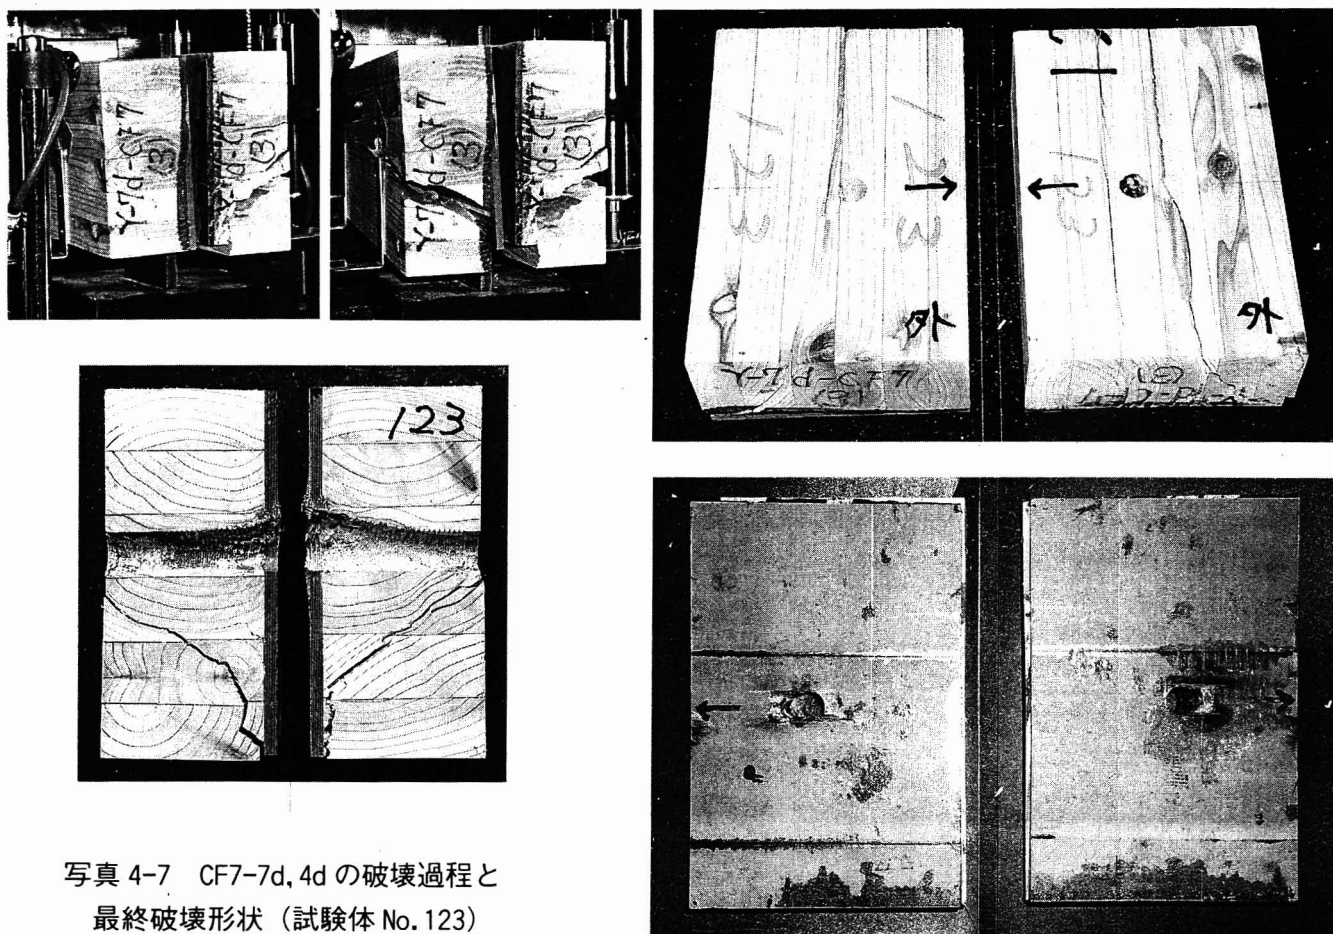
CF7-7d, 4d の破壊過程と最終破壊形状 (試験体 No. 123)
